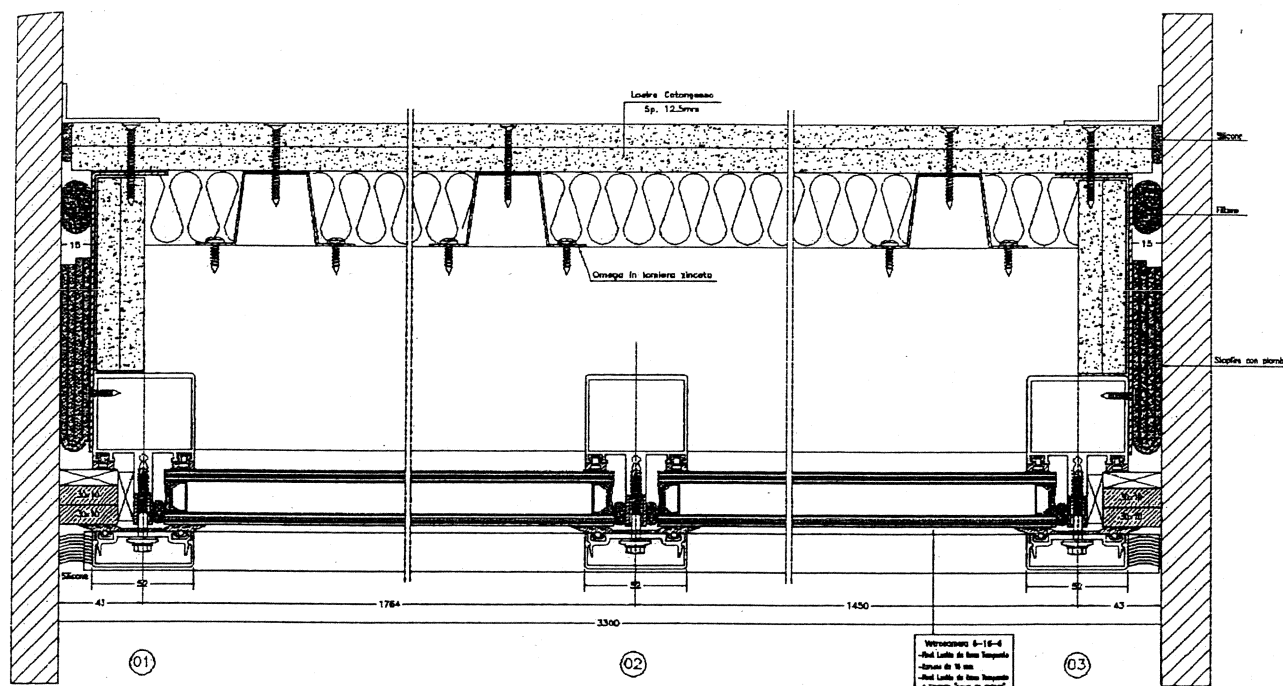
Schema dell'elemento sottoposto a prova. Sezione orizzontale 1-2-3.
